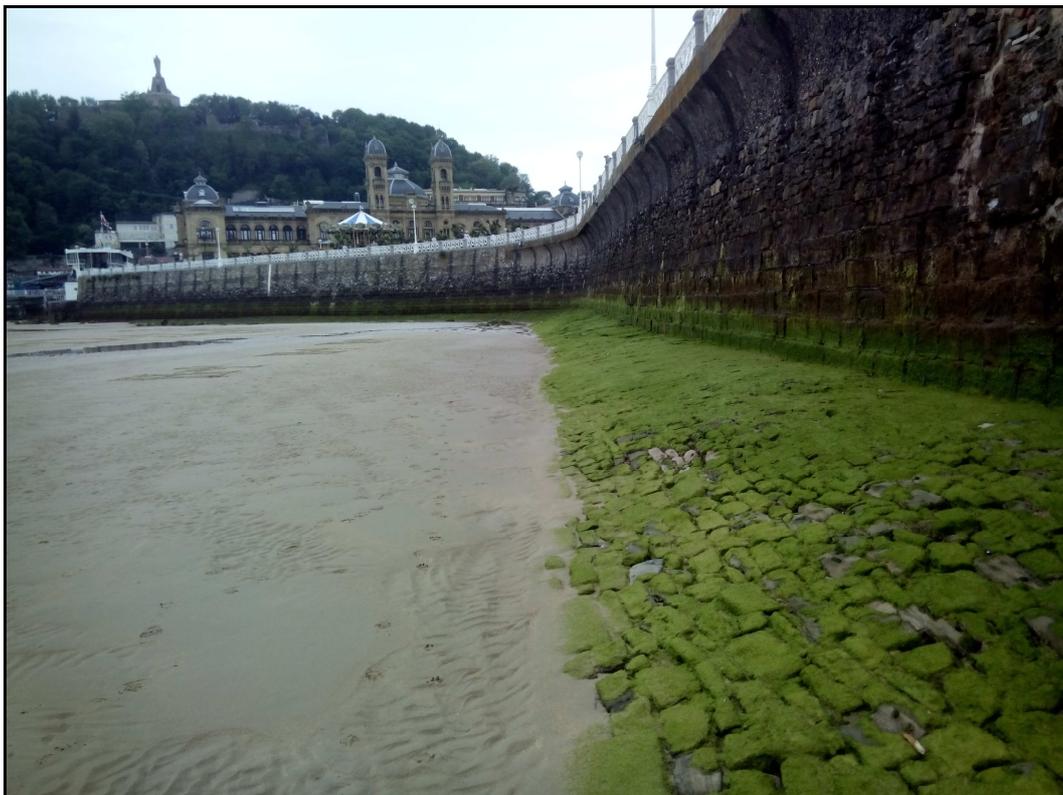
Panorámica de zapata de mampostería a pie de muro en Alderdi-Eder.
